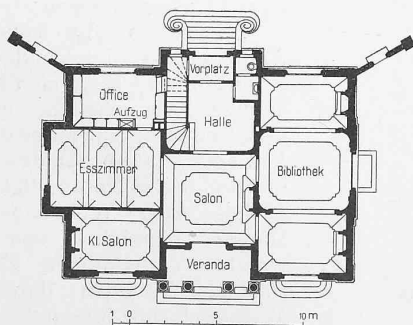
Grundriss vom Erdgeschoss der Villa «Le Pavillon». Masstab 1:400.
